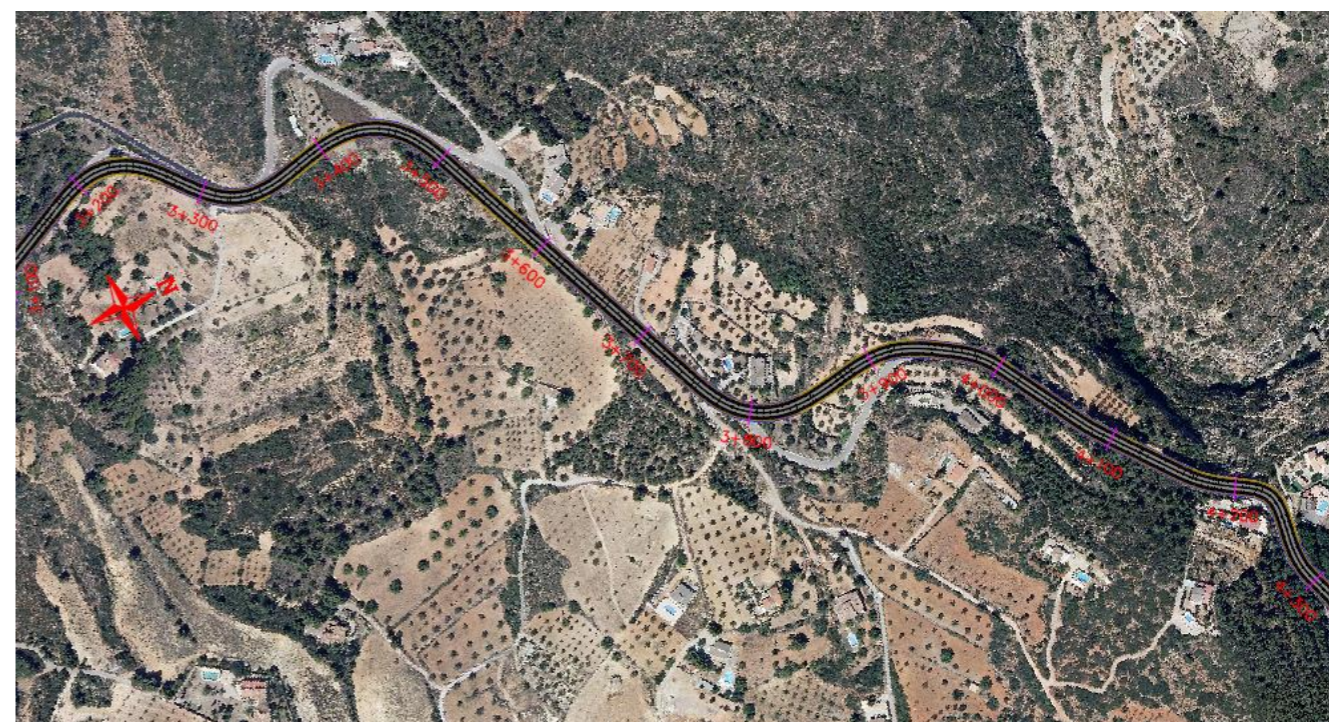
Vista en planta del tramo 2 modificado. (Fuente: Elaboración propia).
